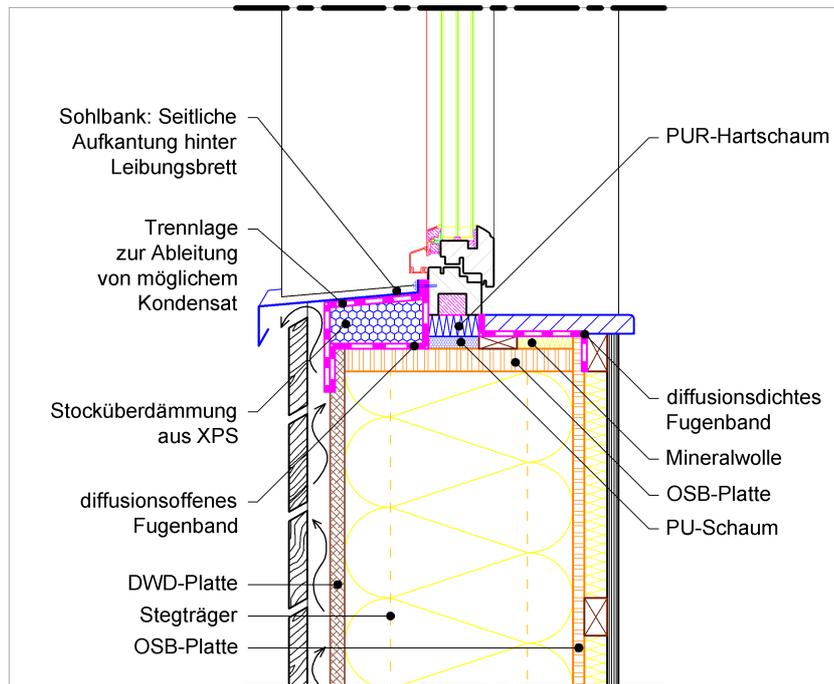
Detail G-P Holzleichtbauelement Parapet
